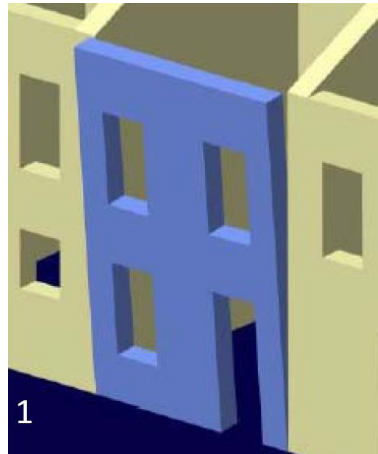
Ribaltamento semplice di parete monolitica a più piani.
